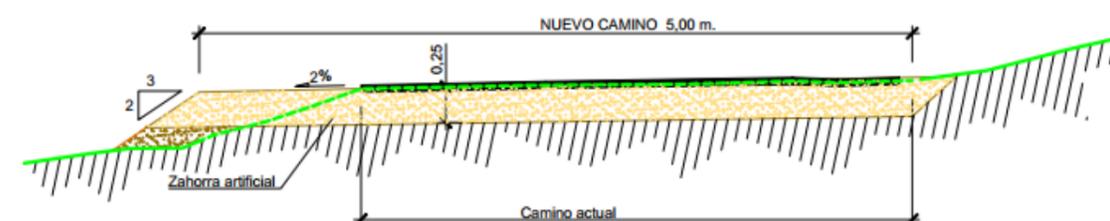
Sección tipo camino de acceso balsa Los Almagros.
